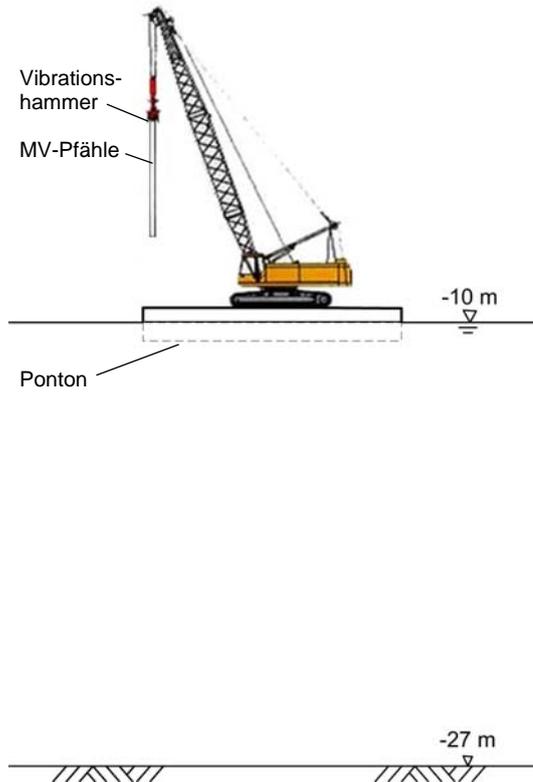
Seilbagger mit Hydraulikvibrationshammer
